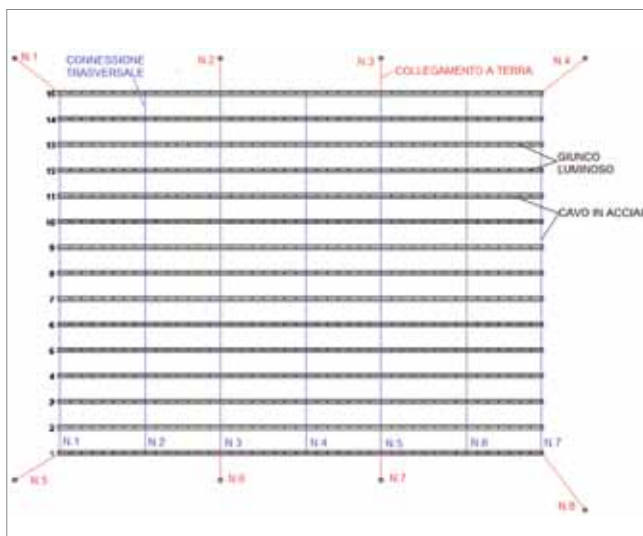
Planimetrie sistema "giunghi luminosi" irrigidito con connessioni trasversali e collegamenti a terra
